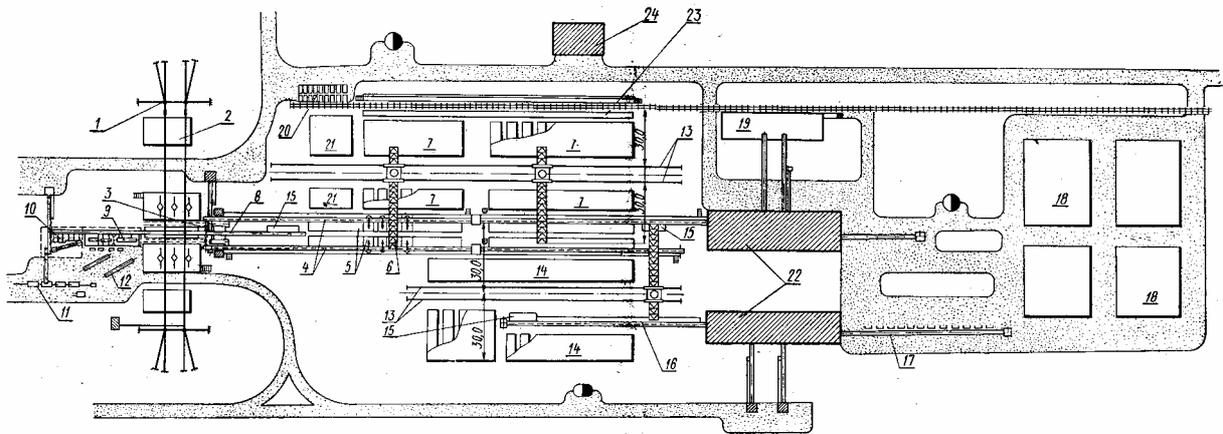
Вывозка хлыстов и разгрузка кабельным краном
